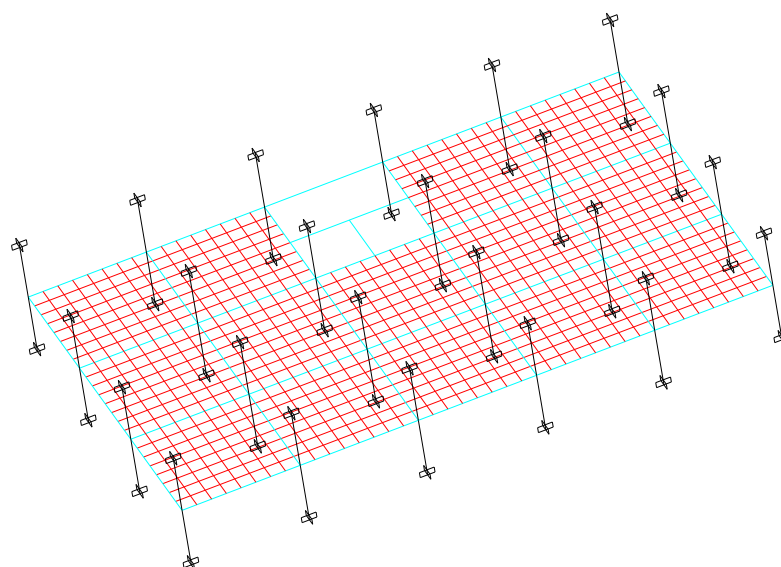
Elementos de pórtico espacial (vigas, nervuras e pilares). Pilares engastados no piso inferior e superior.
